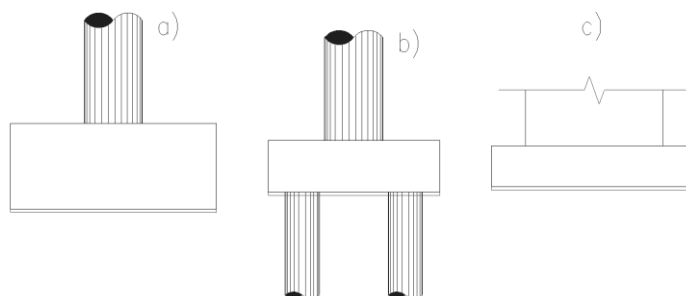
Corte vertical pelas fundações dos: a) Pilares P1, P5 e P6; b) Pilares P2, P3 e P4; c) Encontros
